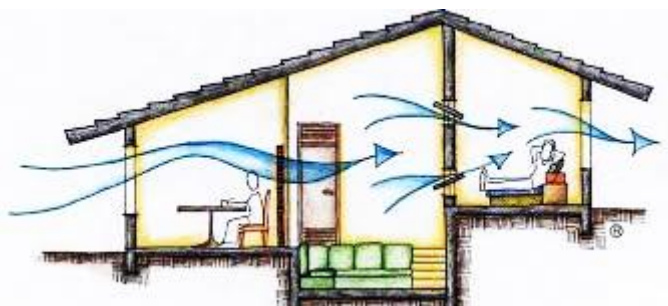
Ventilação natural. Adaptado de (ADENE, 2016)
